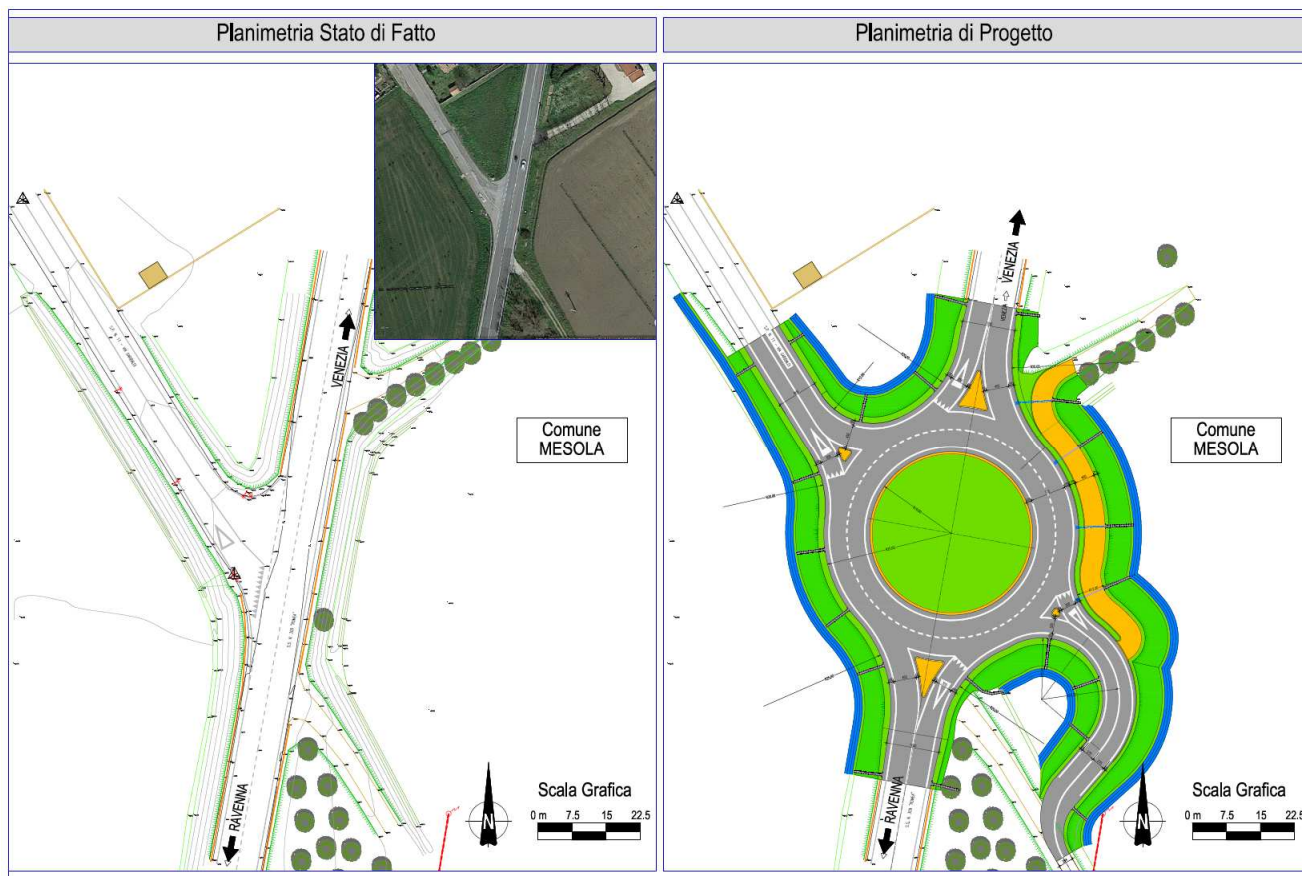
Intervento n°23 – Planimetria Stato di fatto - Progetto
